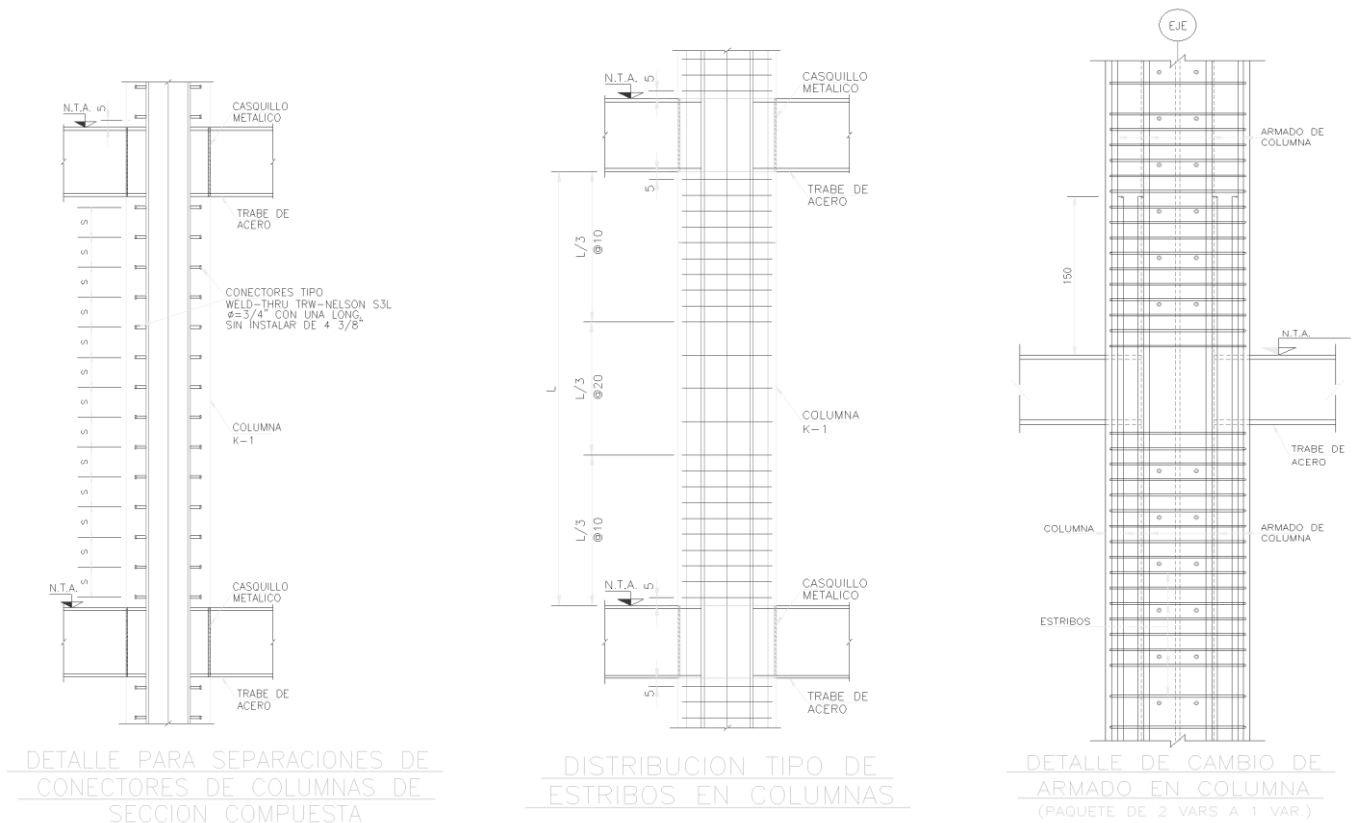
Detalles de conectores, estribos y del cambio de armado. Tomada del plano estructural.
